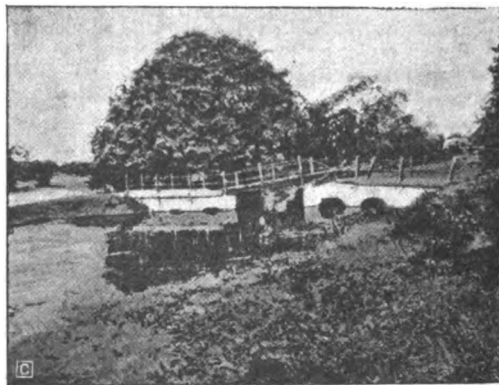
Ponte sopra un canale a Rangpur dopo il terremoto di Assam del 1877. Travata sollevata su una spalla (Da Oldham).
